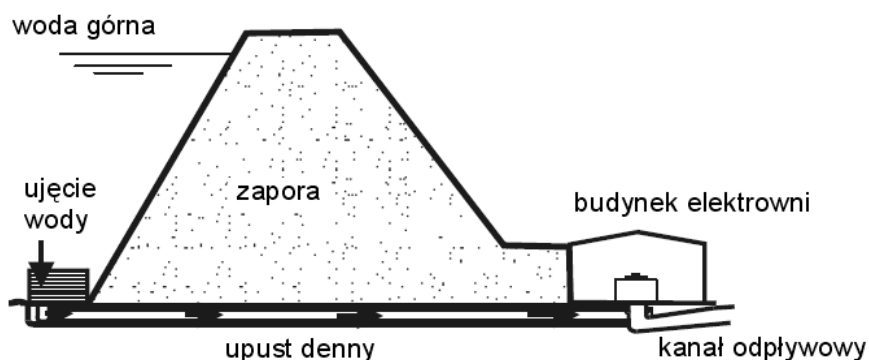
Usytuowanie elektrowni przy zaporach betonowych [17]:
